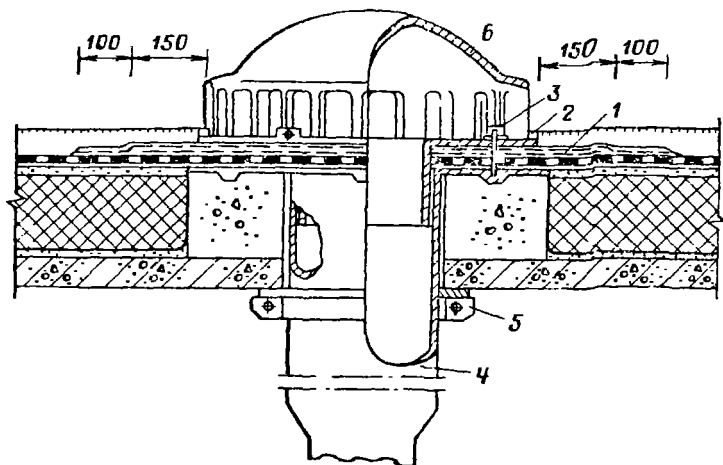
Пример устройства кровли у примыкания к водосточной воронке
